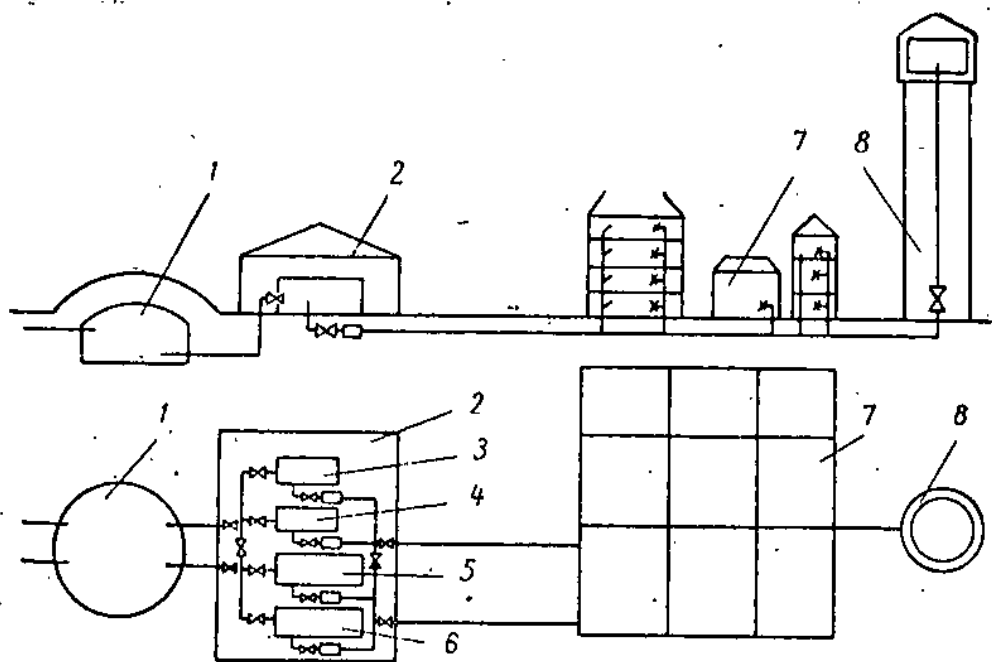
Схема противопожарного водопровода высокого давления (объединенного с хозяйственно-питьевым водопроводом)
